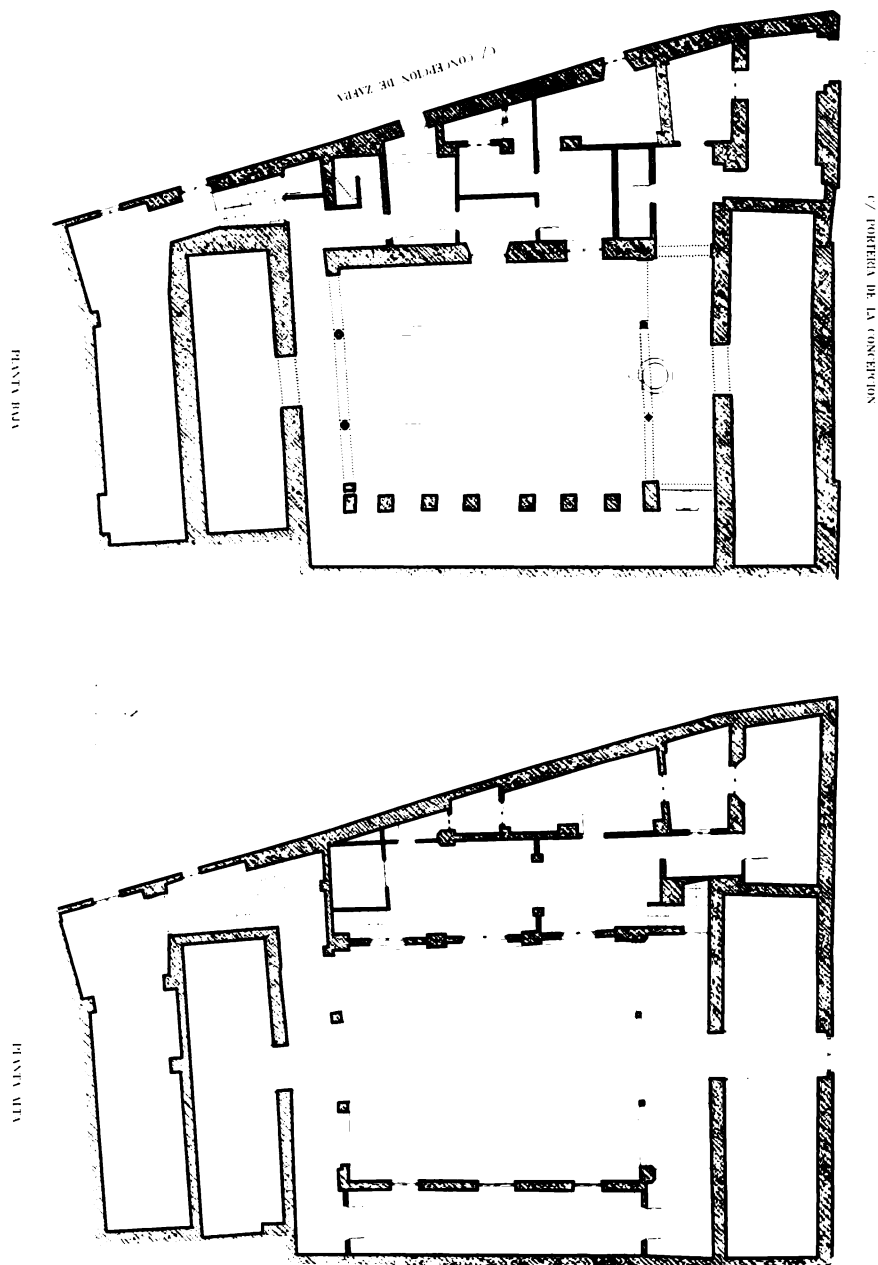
Casa nazari de Zafra (Granada): Plantas baja y alta.
